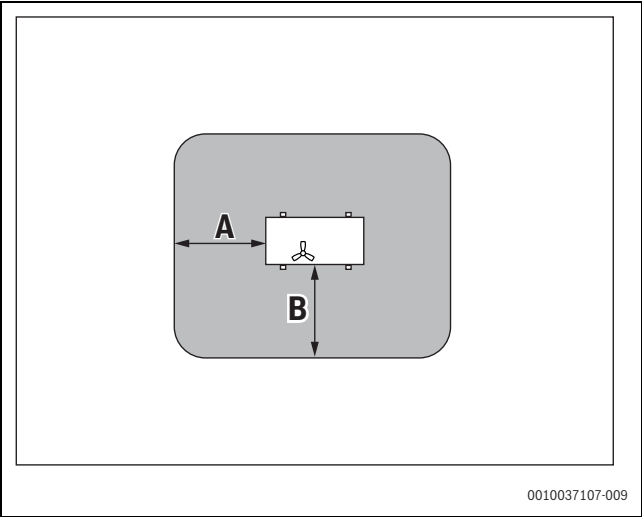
Area di sicurezza in caso di installazione a pavimento, all'interno della proprietà o sul tetto
